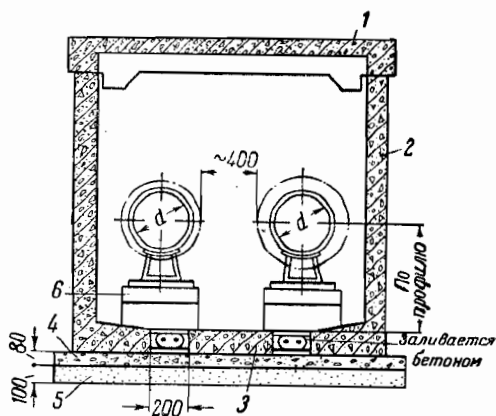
Сборный полупроходной канал из железобетонных блоков.
